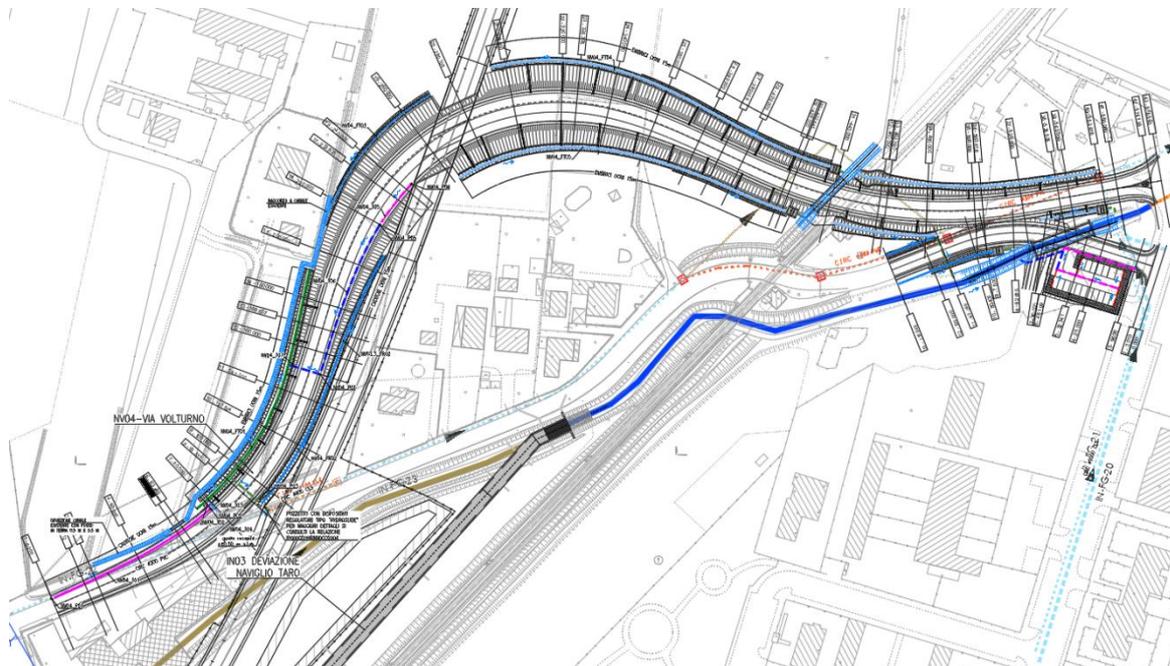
Stralcio planimetrico drenaggio viabilità NV04
